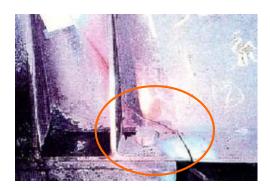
Grieta cerca del apoyo de la viga principal
